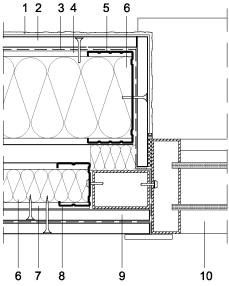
Esquina saliente del sistema Aquapanel® Outdoor W388 (W387).
